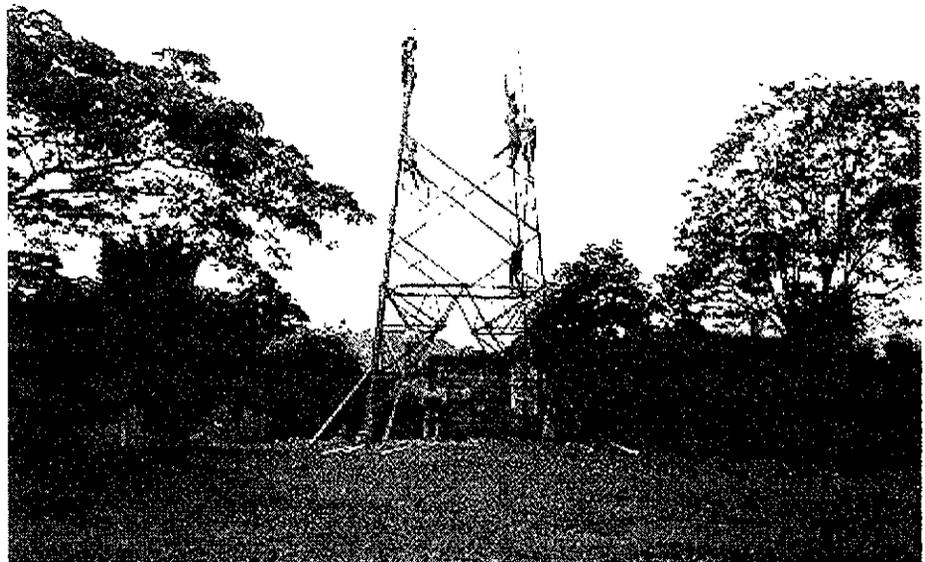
Montaje pieza por pieza de una torre de suspensión de 115 kV, 1 circuito.
